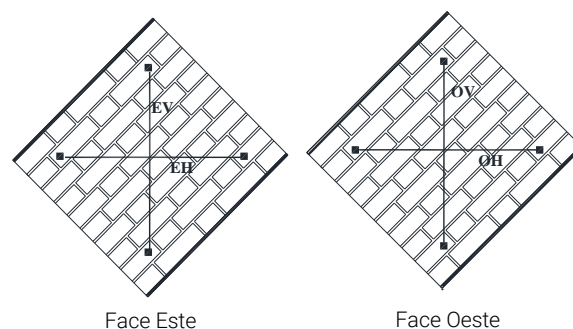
| Localização dos LVDTs colocados nos provetes de parede.
